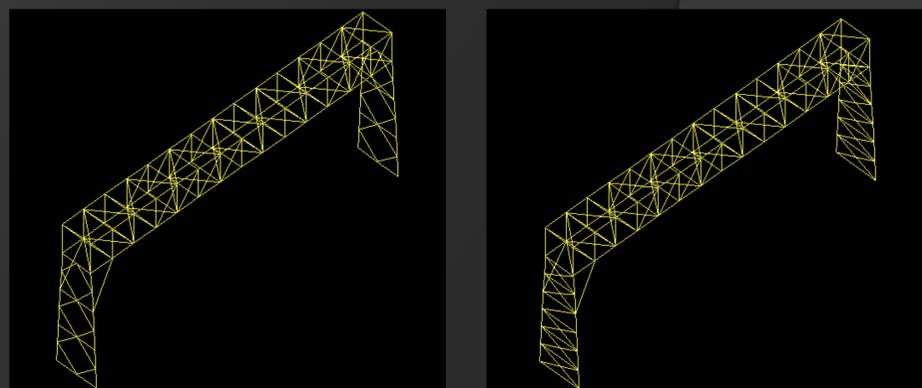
Modelo em 3D: Pilar tipo 1 e tipo 2
